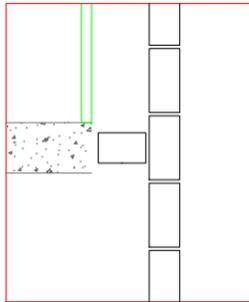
Detalhe construtivo 2 de encontros entre alvenarias de vedação
